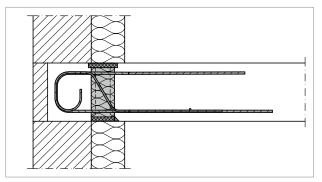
Schöck Rutherma® T type DFi : liaison pour façade en maçonnerie et dalle en béton coulé sur place
